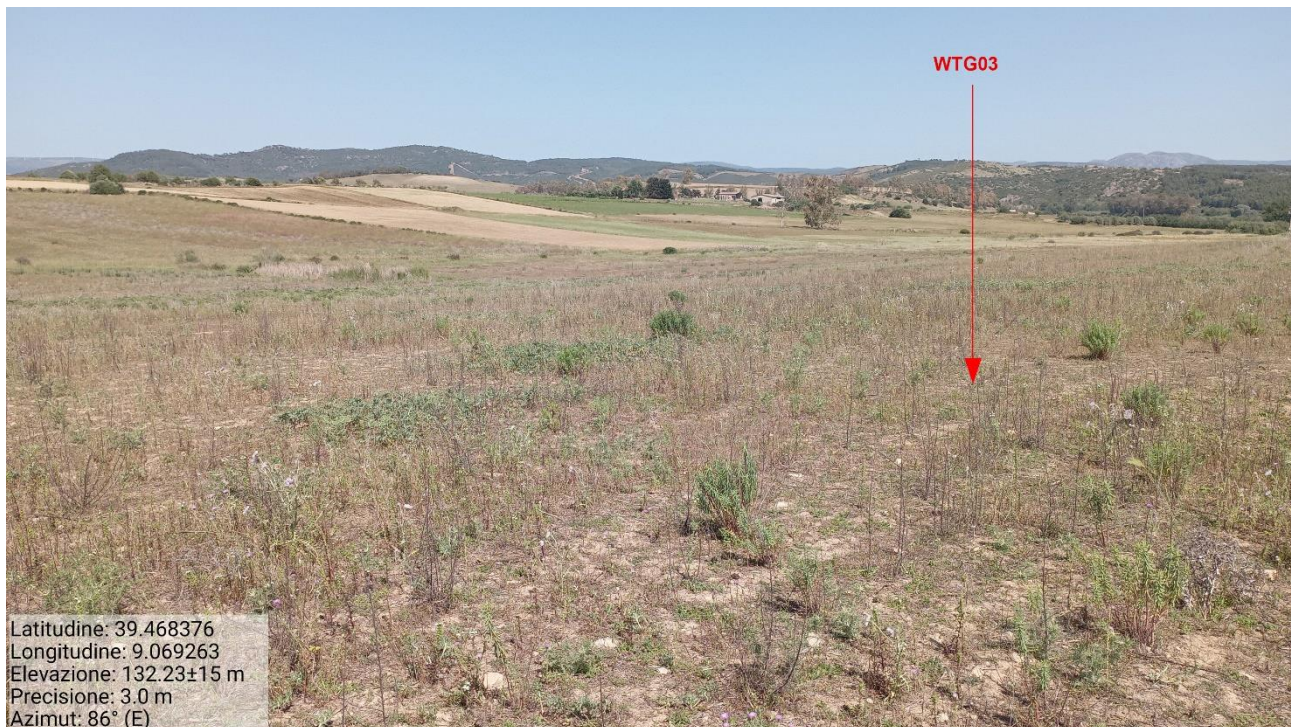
Area interessata dall'installazione della postazione WTG03
